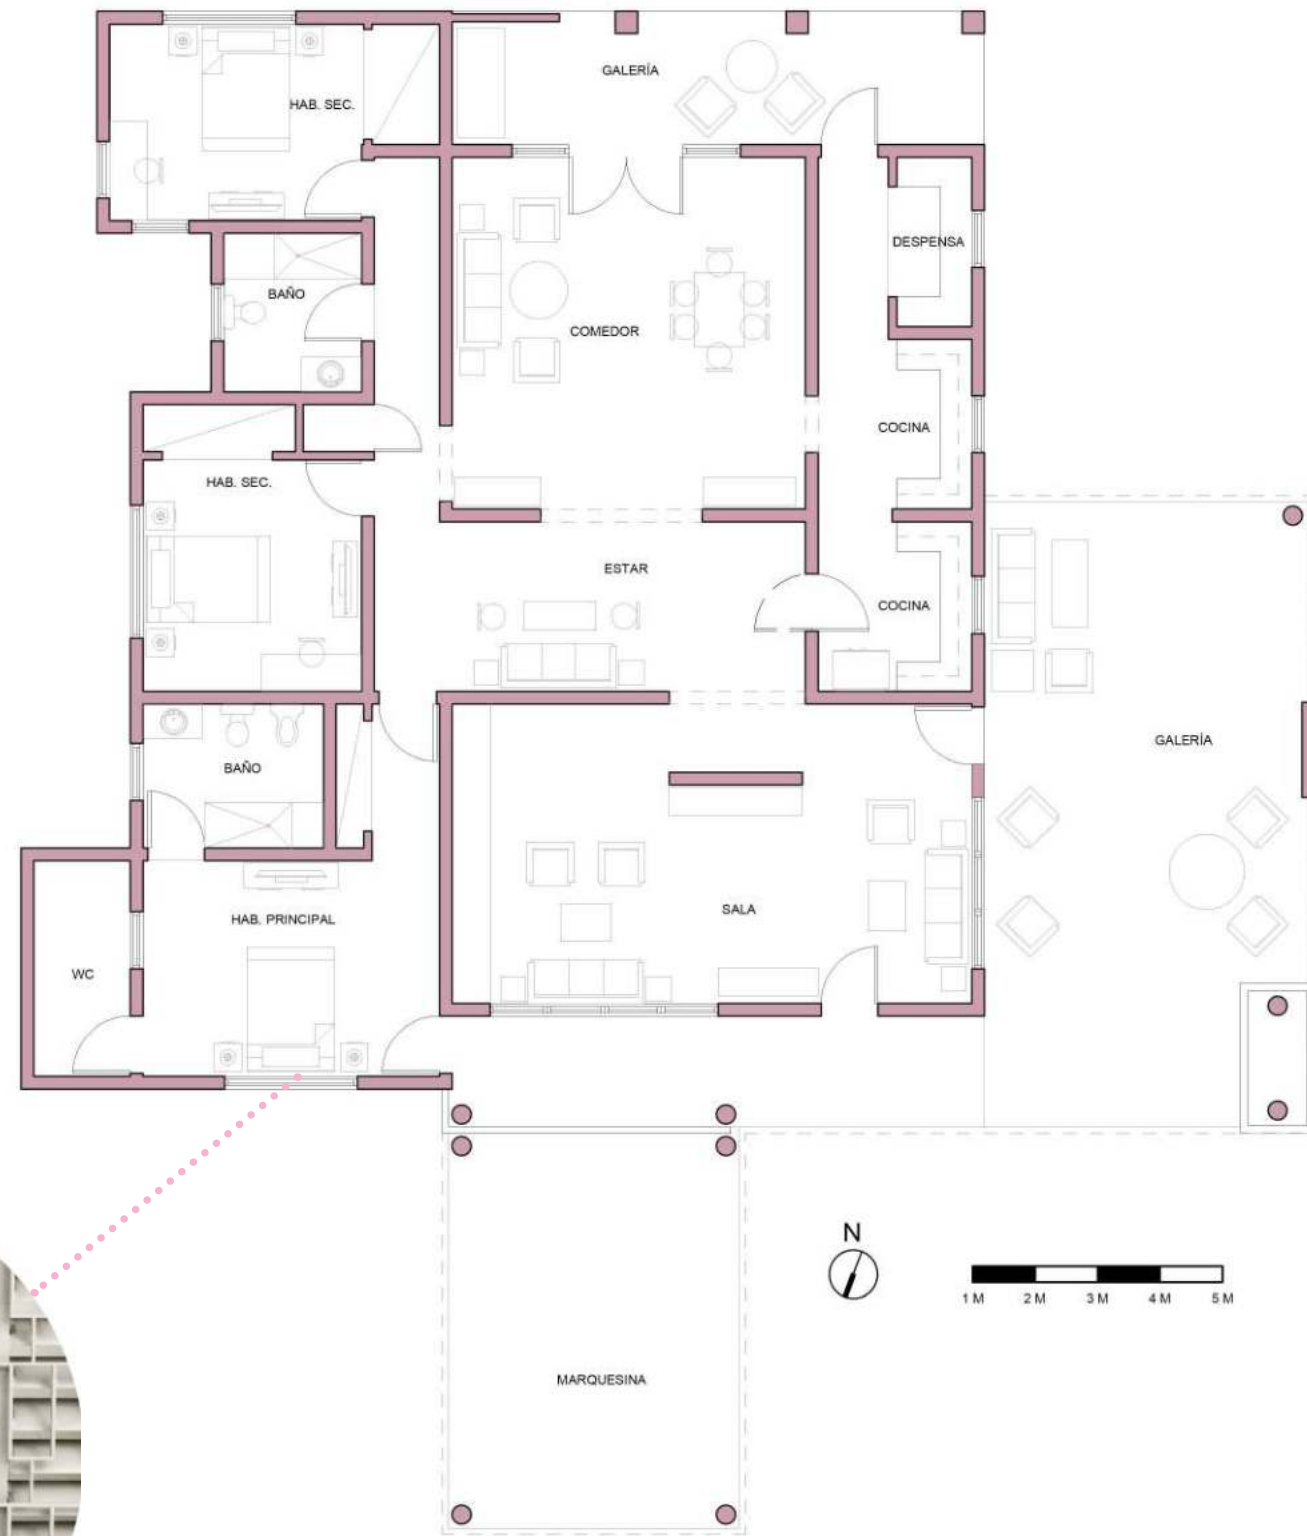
Plano Arquitectónico: "Casa común en el Distrito Nacional". Elaboración propia.
